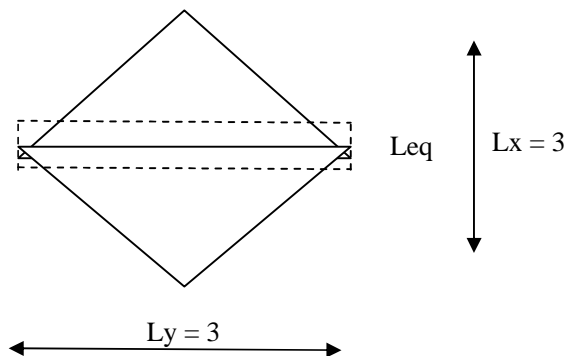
Lebar Equivalen pada Balok Induk Tipe Beban Trapesium
